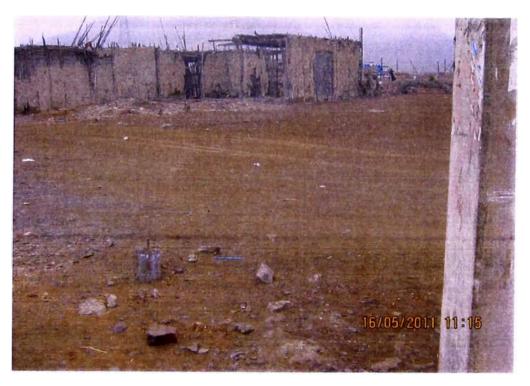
UBICACIÓN DE BM6 (COTA=236.152), EN ESQUINA DE PUENTE DE CONCRETO QUE PERMITE EL INGRESO AL CENTRO POBLADO CANTERA, SE COLOCO FIERRO
